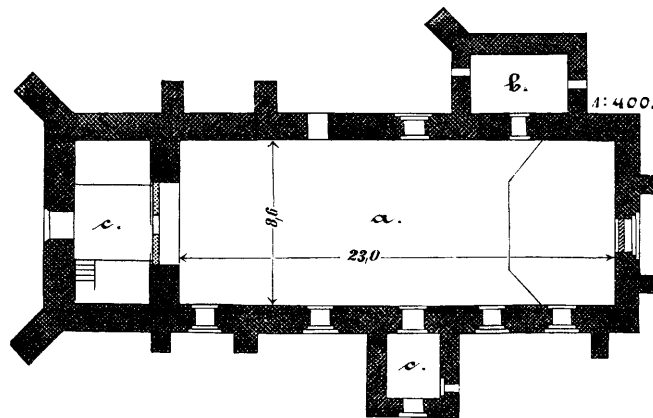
Grundriss der Kirche zu Prangenau.
